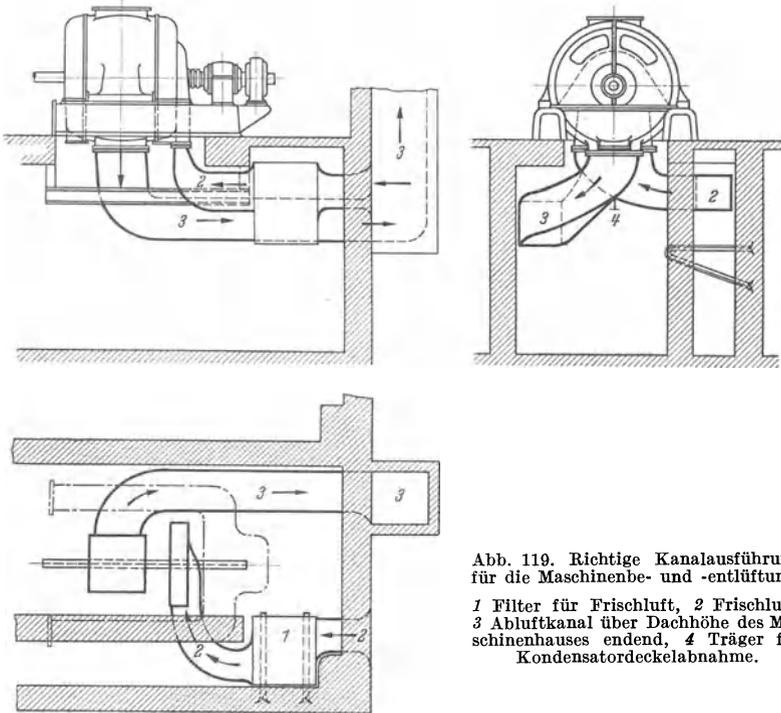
Richtige Kanalausführung für die Maschinenbe- und -entlüftung.
